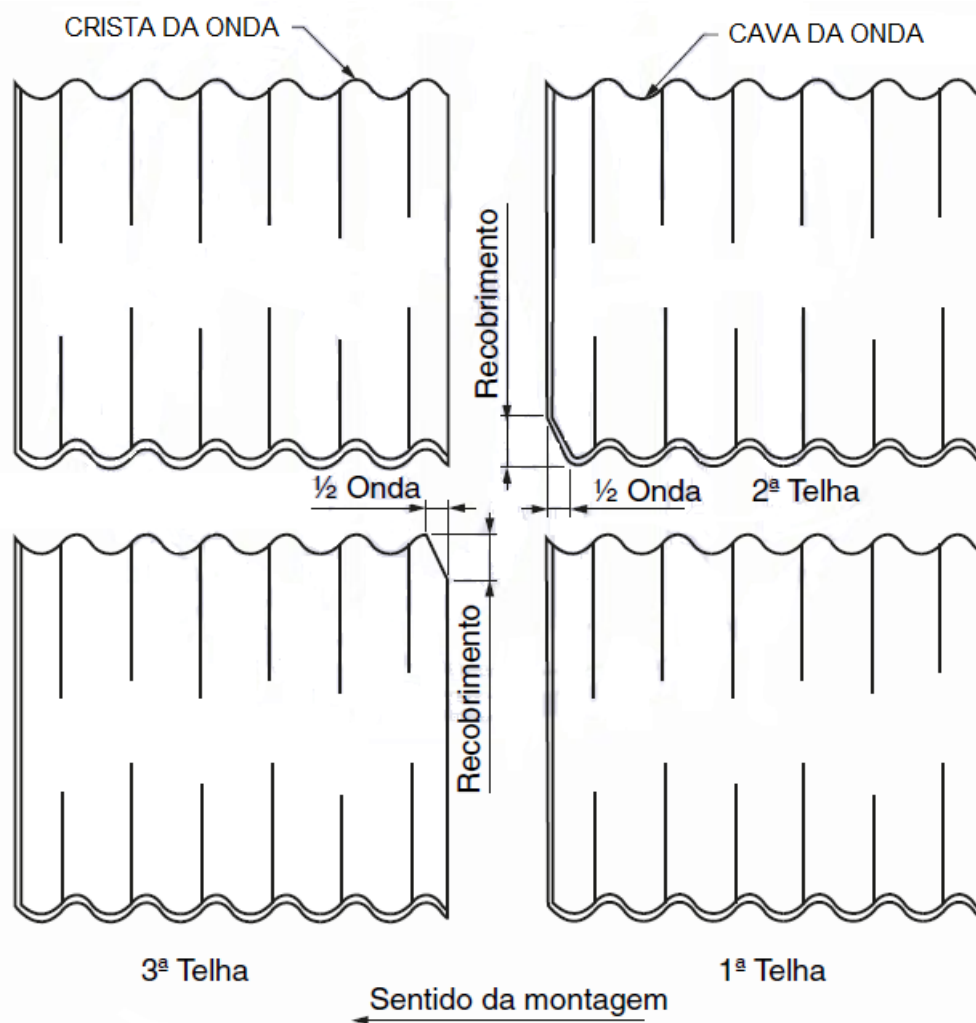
Esquema de execução do corte de canto das telhas apresentado na NBR 7196. Fonte: Adaptado de ABNT (2020).
